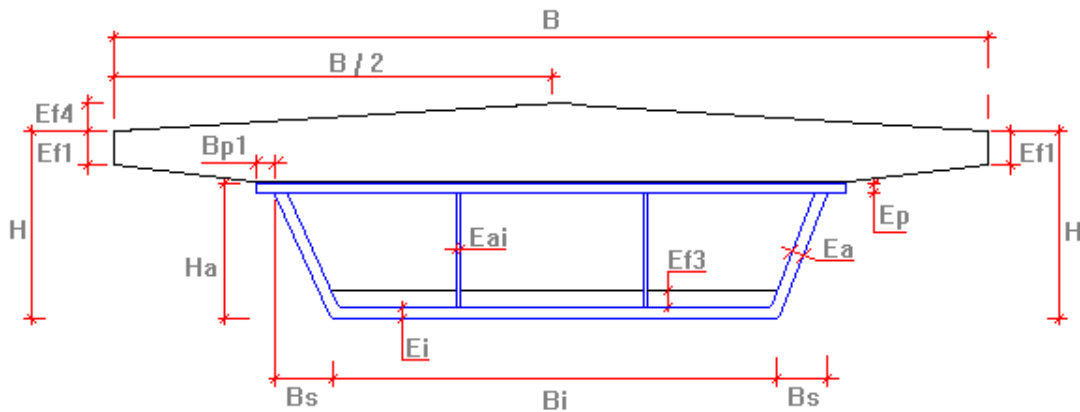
Sección transversal del puente (cajón multicelular cerrado).
